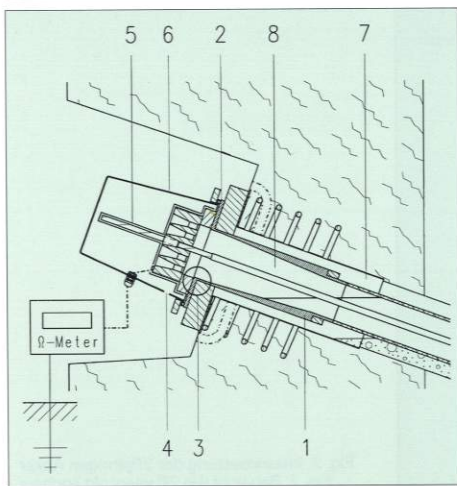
Zusatzanker mit vollständig elektrisch isolierter Ankerkopfkonstruktion (Typ «Werschweissung») Fig. 3: Additional anchor with electrically insulated anchor head (shop welded type)
